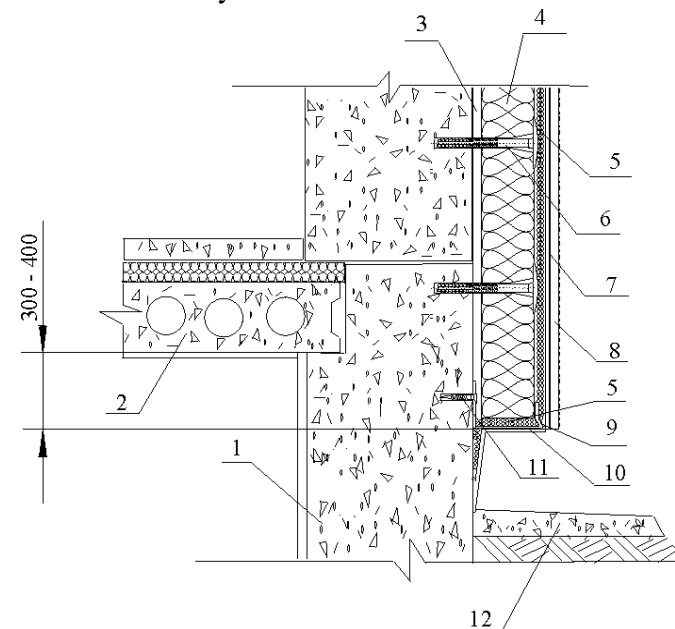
Фрагмент устройства скреплённой теплоизоляции в нижней части здания.
